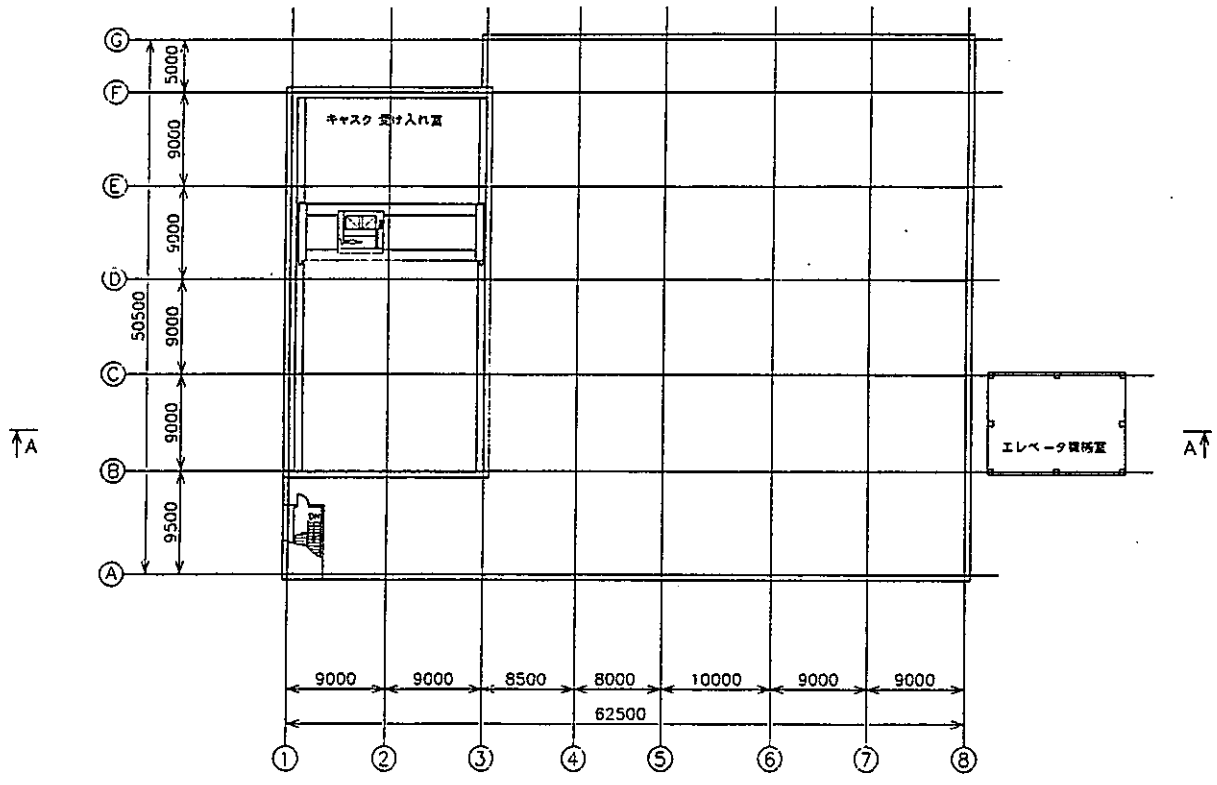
(3/4) 地上施設：廃棄物受け入れ・検査施設機器配置図（屋上階平面図）
